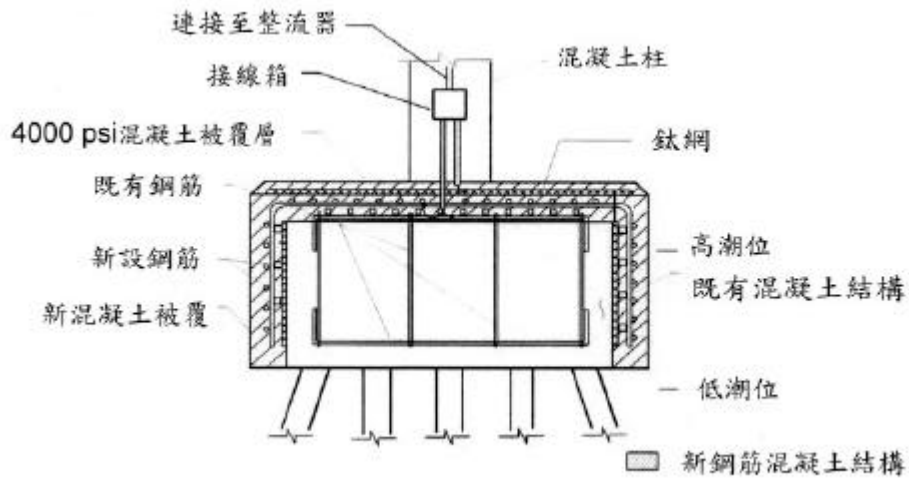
鈦網陽極-外覆鋼筋混凝土保護結構
